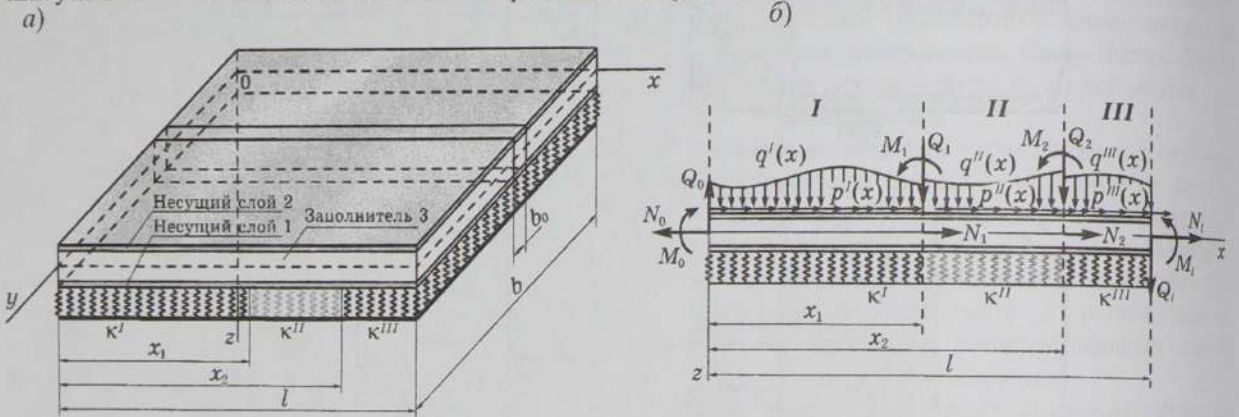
Расчетная схема прямоугольной трехслойной пластины
